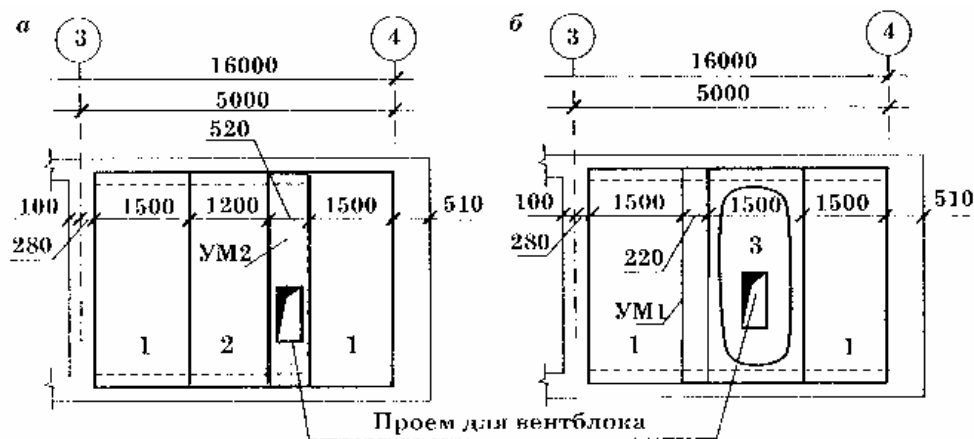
Изображение вентиляционных каналов на плане перекрытий
